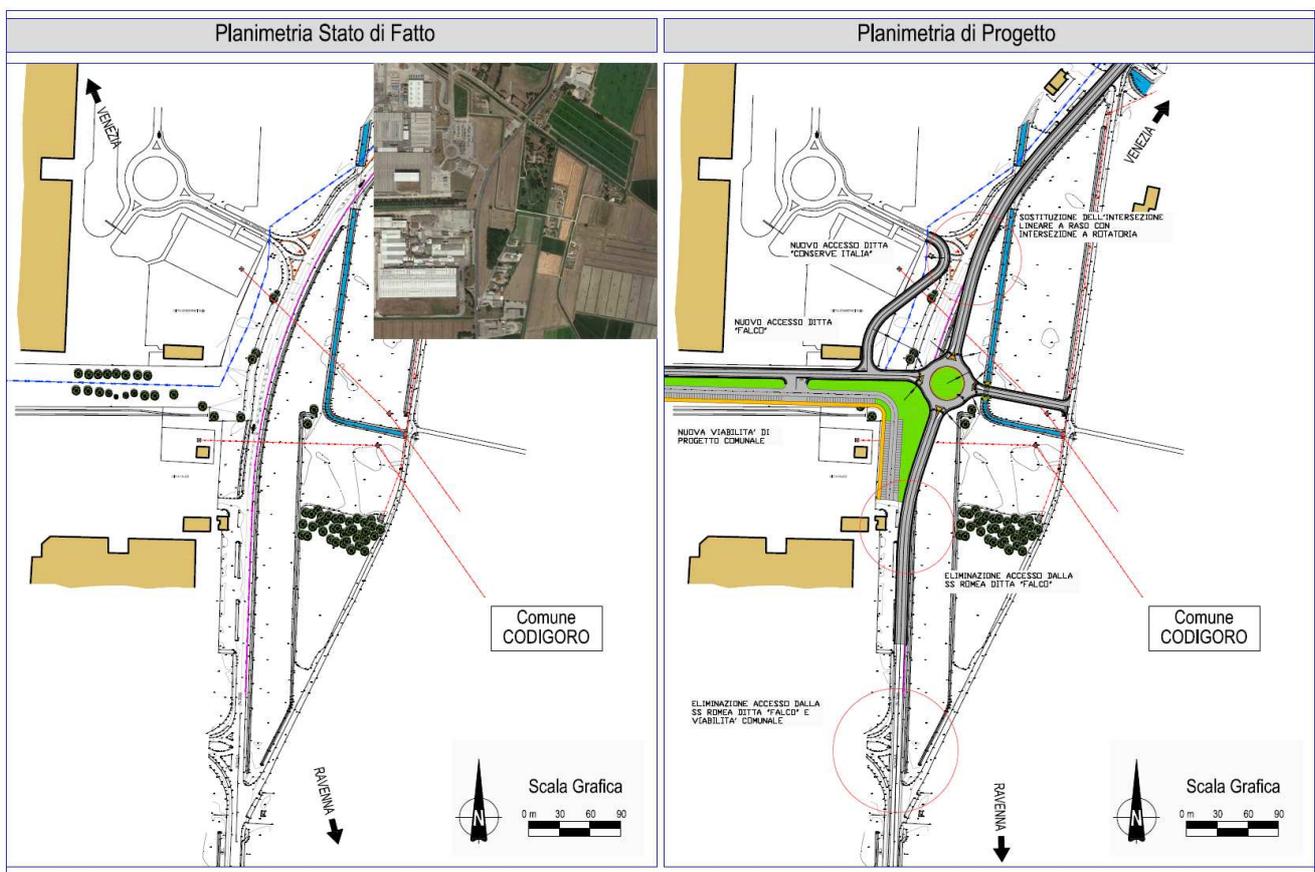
Intervento n°18 – Planimetria Stato di fatto - Progetto
